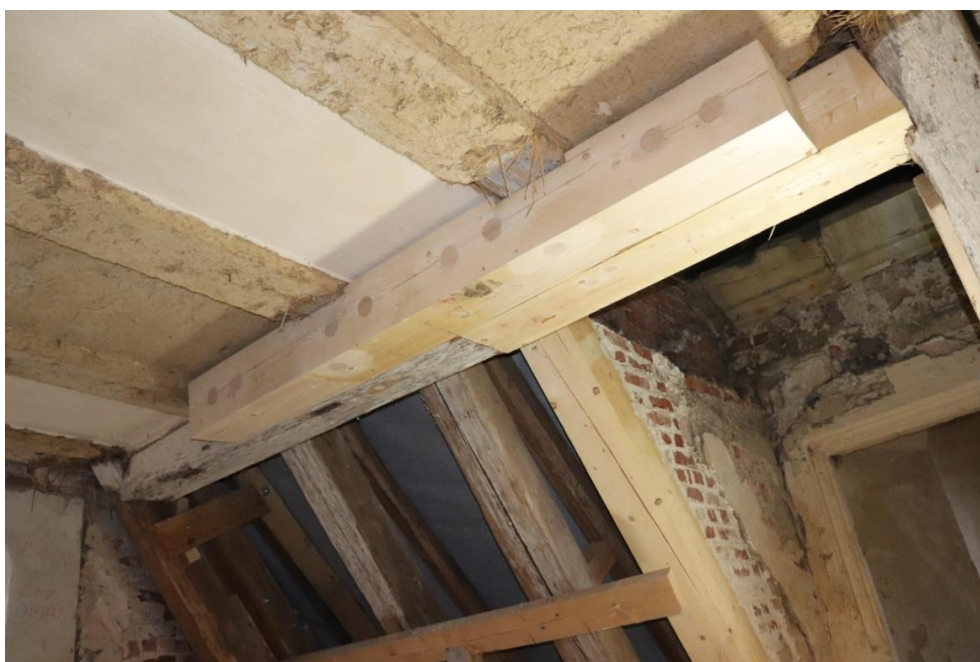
1: Wand a (Übersicht): nördliche Dachkonstruktion; 4 Leersparren, Kehlbalken der Dachkonstruktion sind gleichzeitig Deckenbalken des 1. Dachgeschosses
